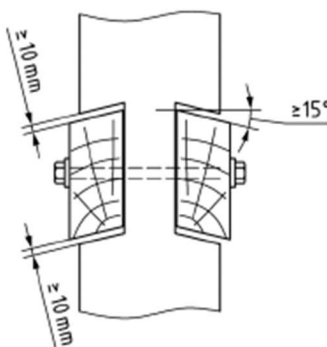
Exemple de conception drainante d'un assemblage entrain moisés - poteau
